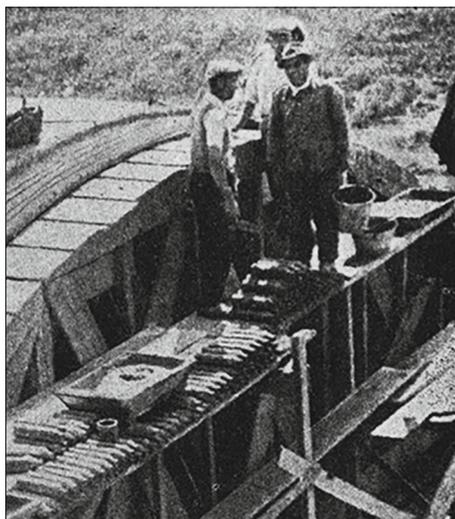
Niederlande. Errichtung einer Halle mit Röhrengewölbe auf Schalung mit beweglichem Gerüst am Kopf des Baus. Foto vor/um 1949.
